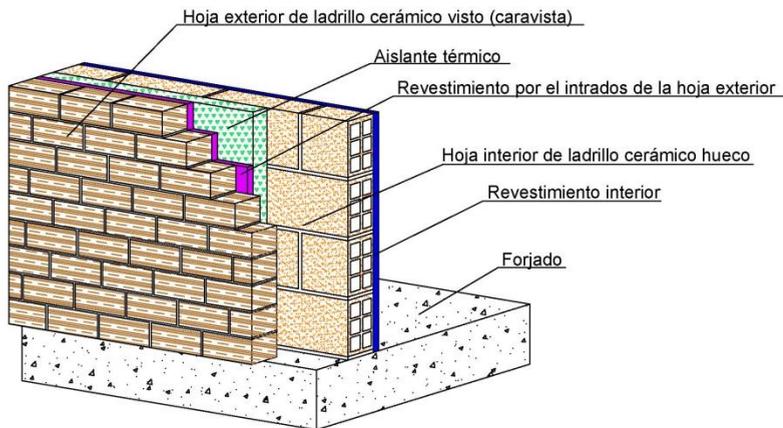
Detalle de fachada caravista de dos hojas. Abril 2015.
